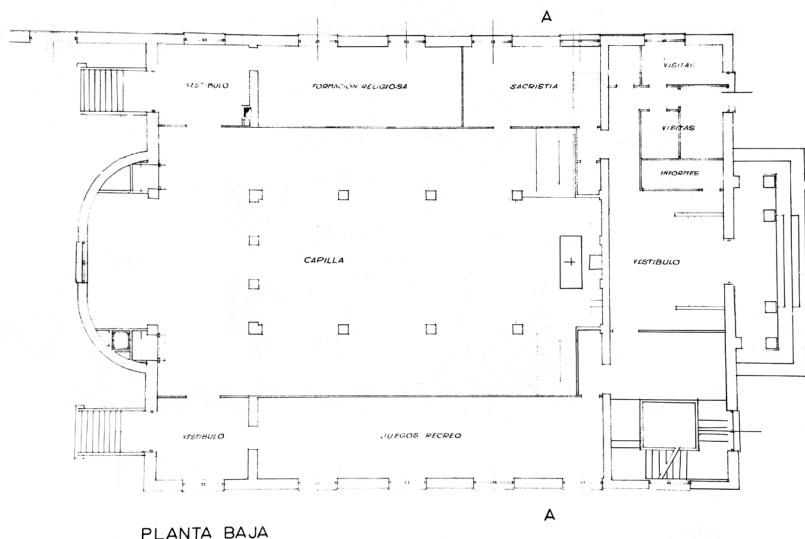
Colegio menor Alfonso de Castro. Planta de la capilla. Detalle del plano del proyecto de reforma y aumento de planta. AHPZa. DPV. 58/14. Foto: RAG-L.
